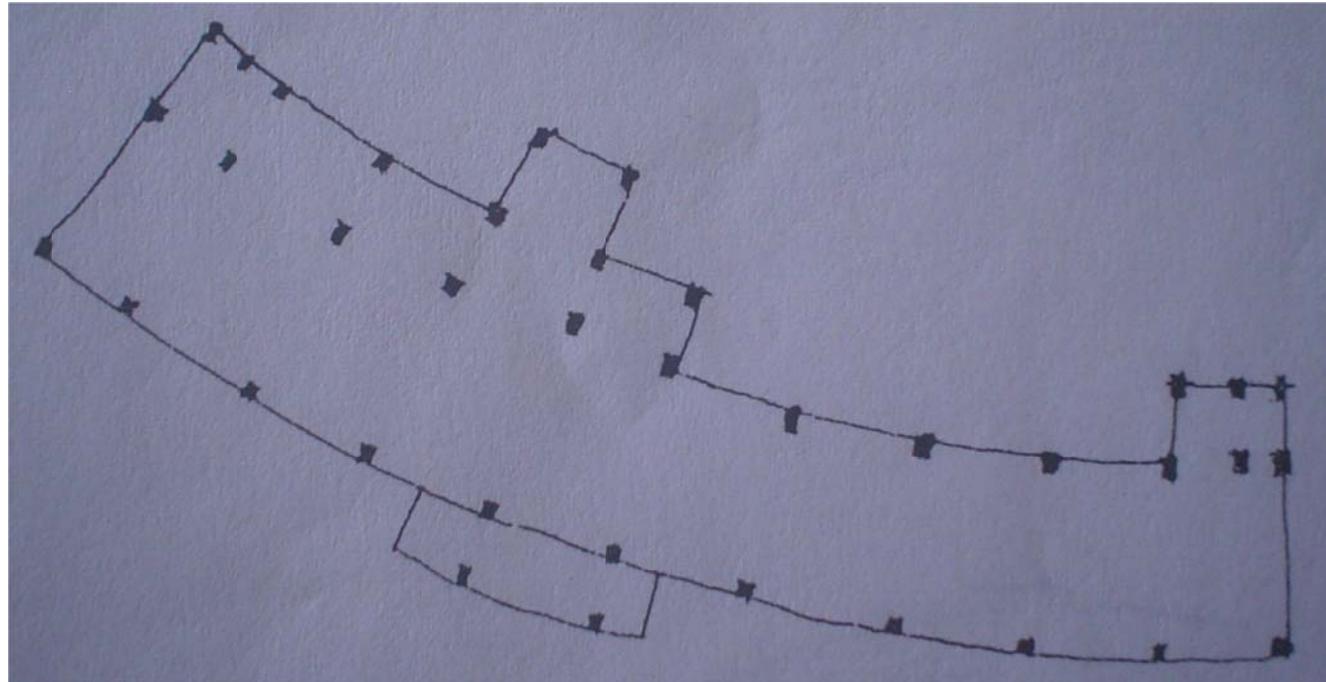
Planta baja. Uso de pilotis para crear una planta libre. Fuente: Mera, Gino; Wong, Jessica; Yu Lee, Pilar. Los arquitectos. Movimiento moderno Guayaquil 1940-1970
